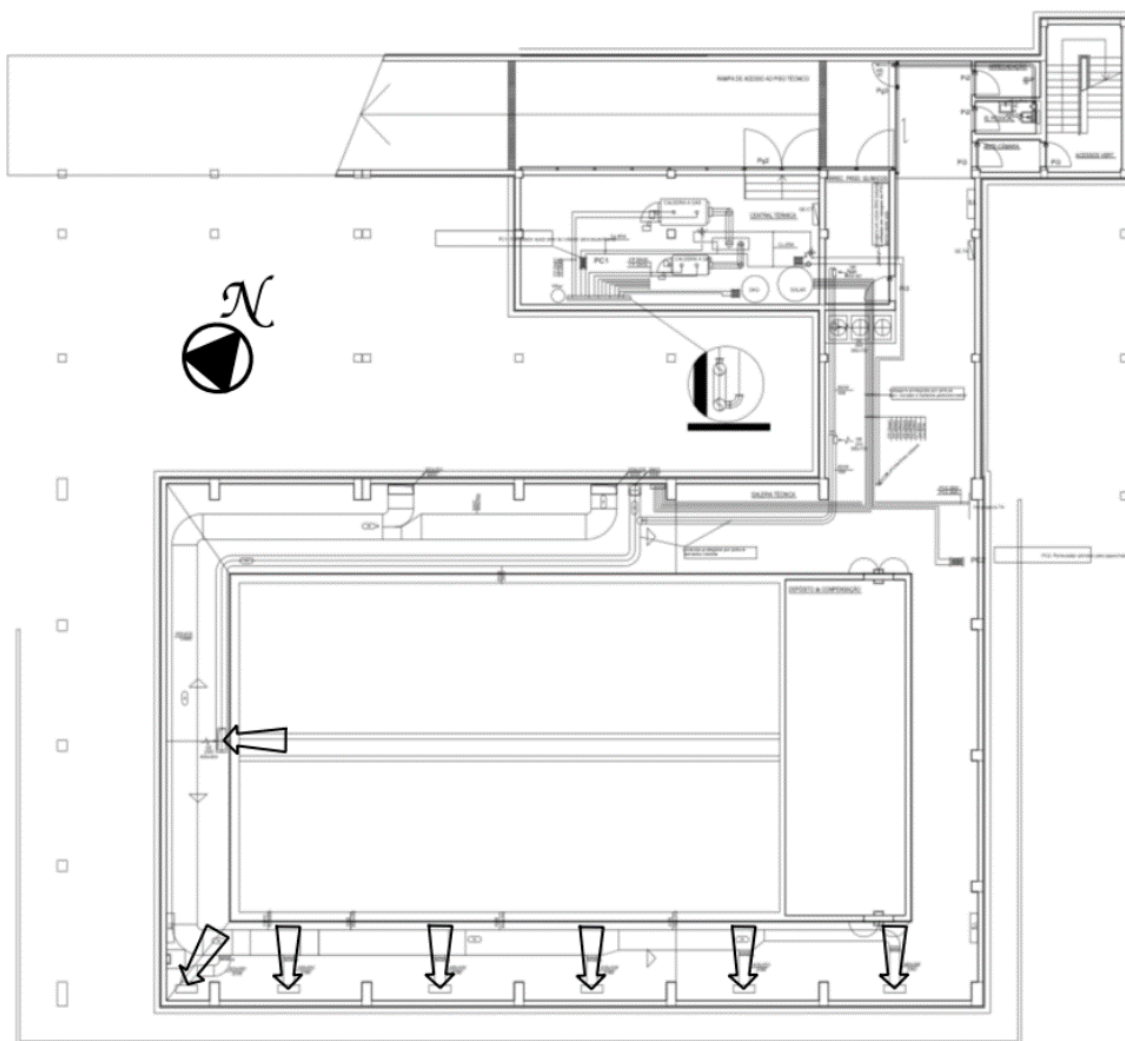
Planta do Piso -1 do edifício da Piscina Municipal com identificação de grelhas de aspiração de ar na nave do tanque (na fachada SE pelo interior, no paramento onde assentam os vãos envidraçados).
